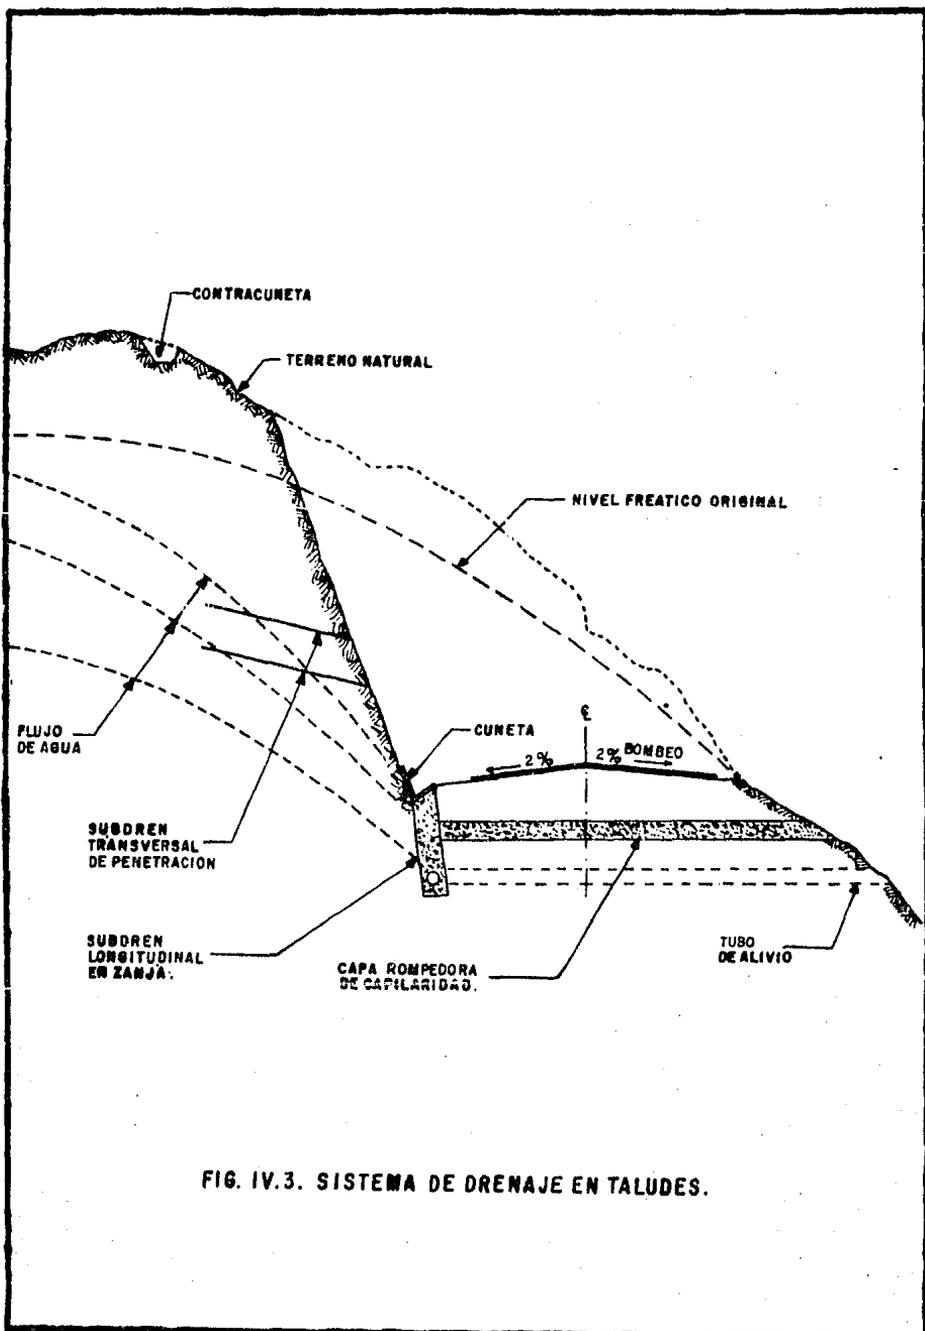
SISTEMA DE DRENAJE EN TALUDES.
